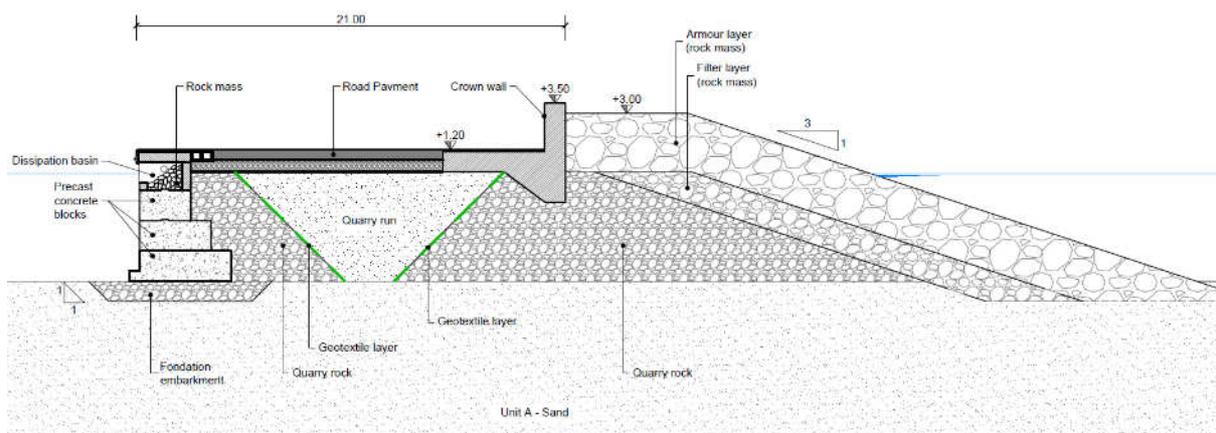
Molo Claudio – Sezione preliminare di Progetto (Sezione B-B)
